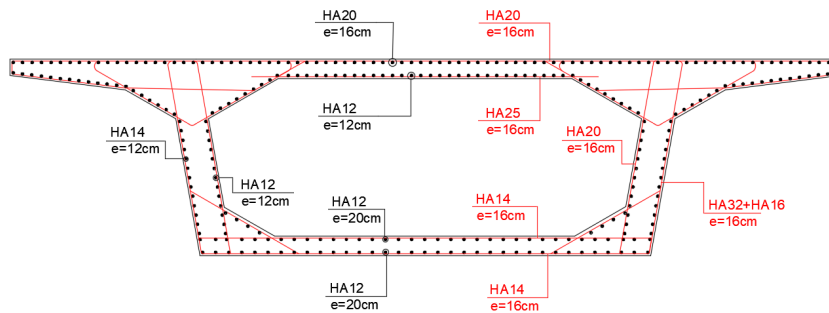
Ferrailage du voussoir sur clef.
